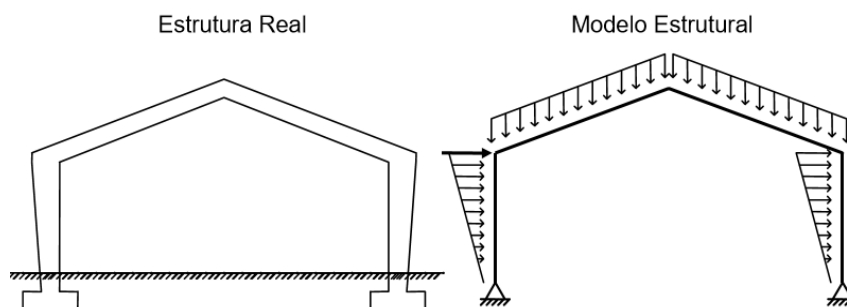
Corte transversal da estrutura (real) e seu modelo estrutural.
